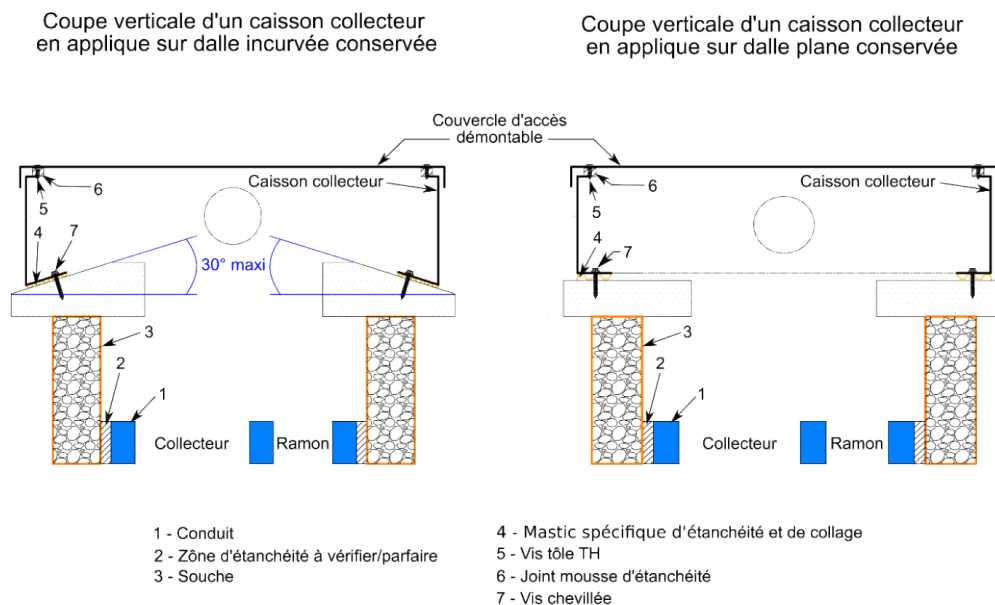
Coupe verticale d'un caisson collecteur CCV en applique (sans goutte d'eau) sur dalle existante
